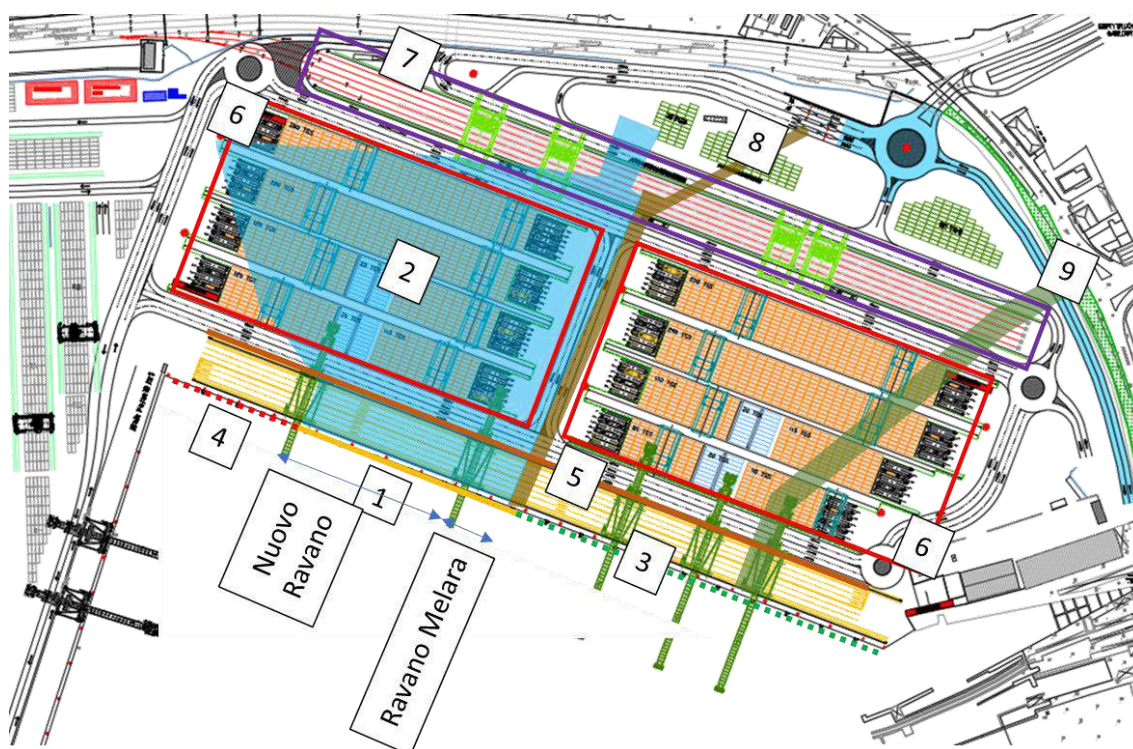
Individuazione in pianta delle due tratte della nuova banchina Ravano
